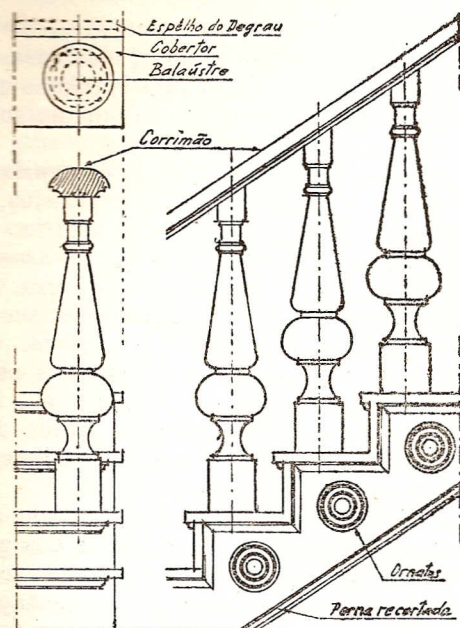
BALAUSTRADA DE MADEIRA NAS ESCADAS À INGLESA
